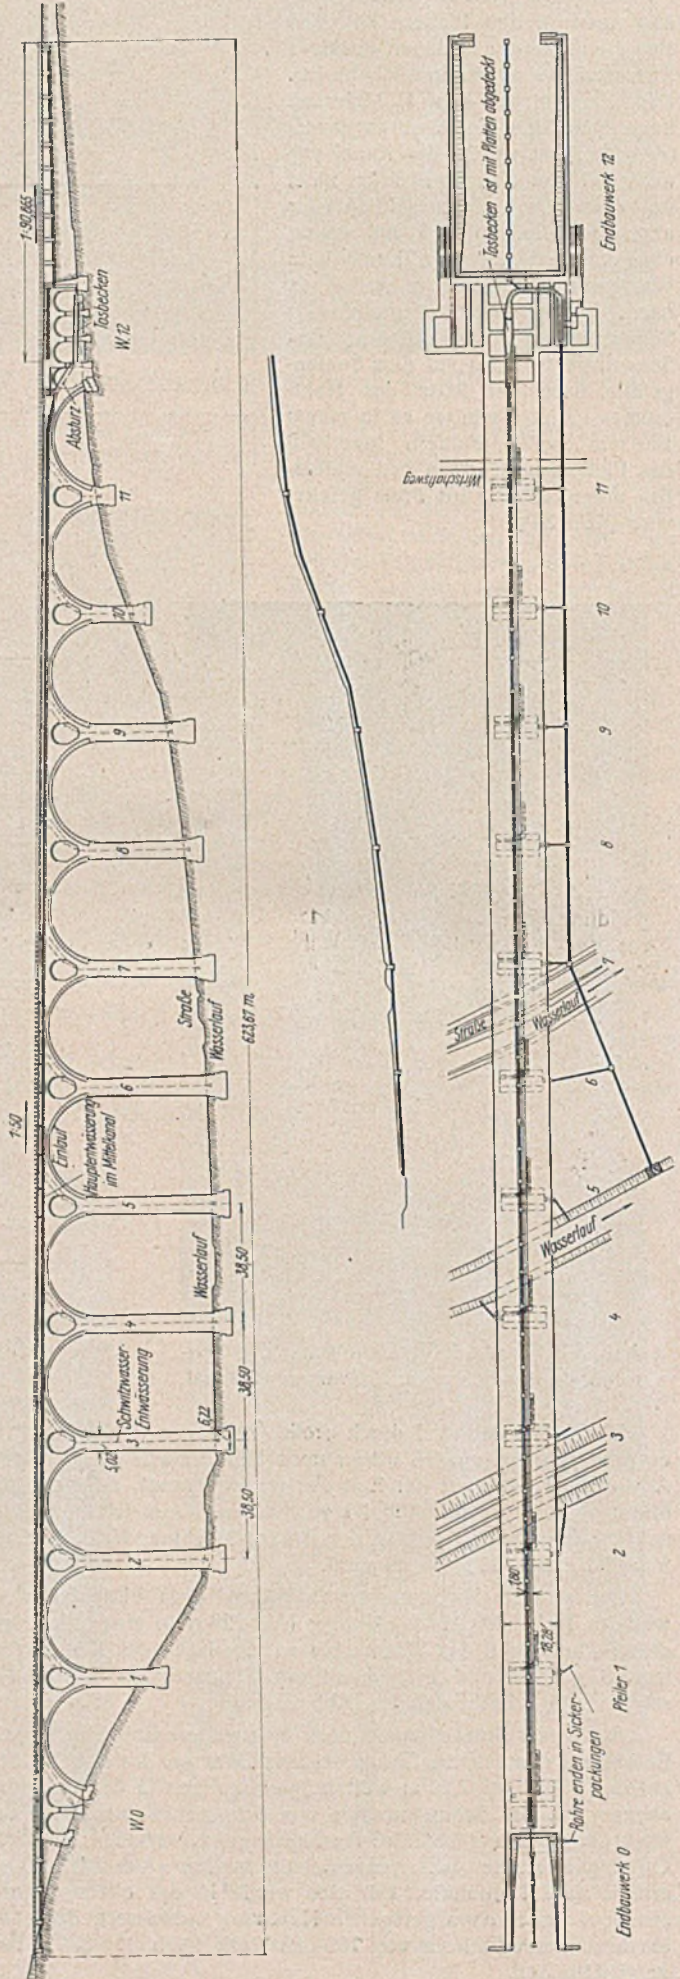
Bauwerk VI, Übersicht der Brückenentwässerung. Längsschnitt, Draufsicht, Querschnitt.
